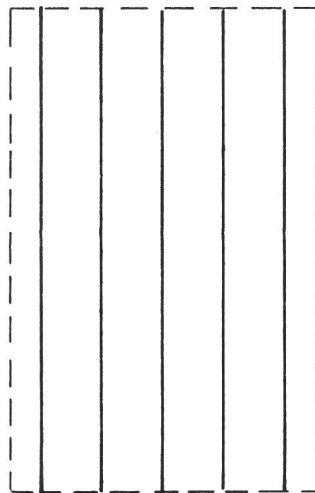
Zur Ermittlung einer Momenten-Krümmungsbeziehung unter Berücksichtigung der Tragwirkung des Betons in der Zugzone betrachteter Abschnitt eines Stahlbetonbalkens
